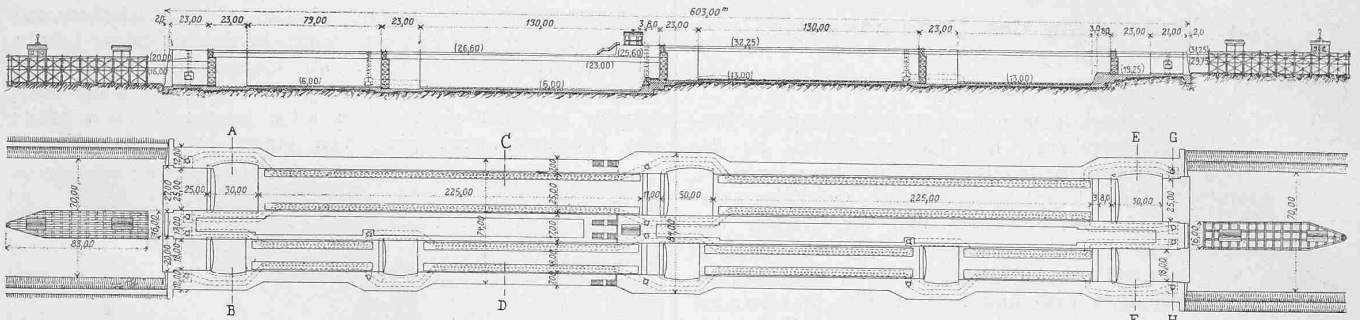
Zweistufige Zwillings-Schleusen. — Grundriss und Längenschnitt. Masstab 1:4000.
